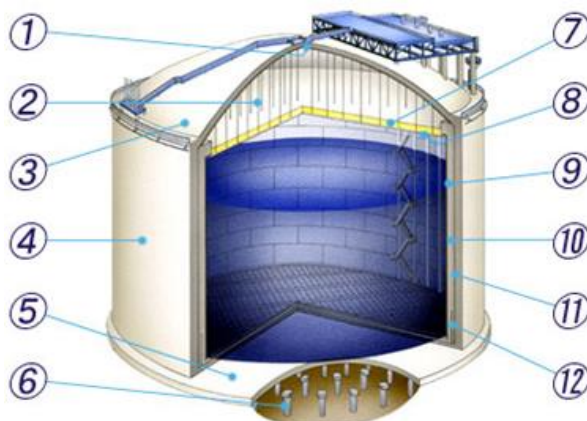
Конструкция железобетонного резервуара с замкнутой наружной оболочкой:
